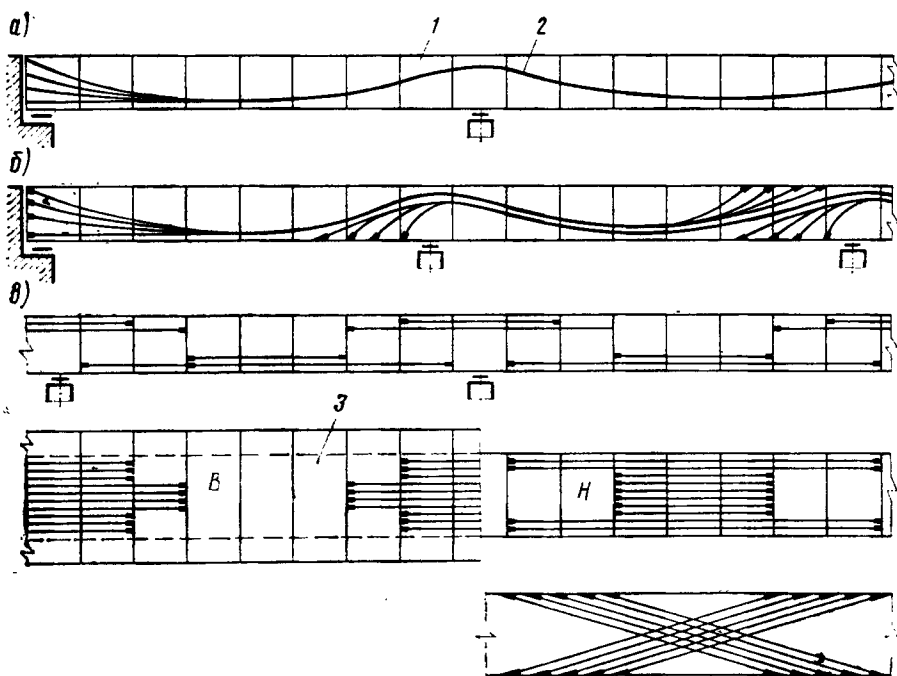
Армирование сборных коробчатых пролетных строений напрягаемой арматурой:
